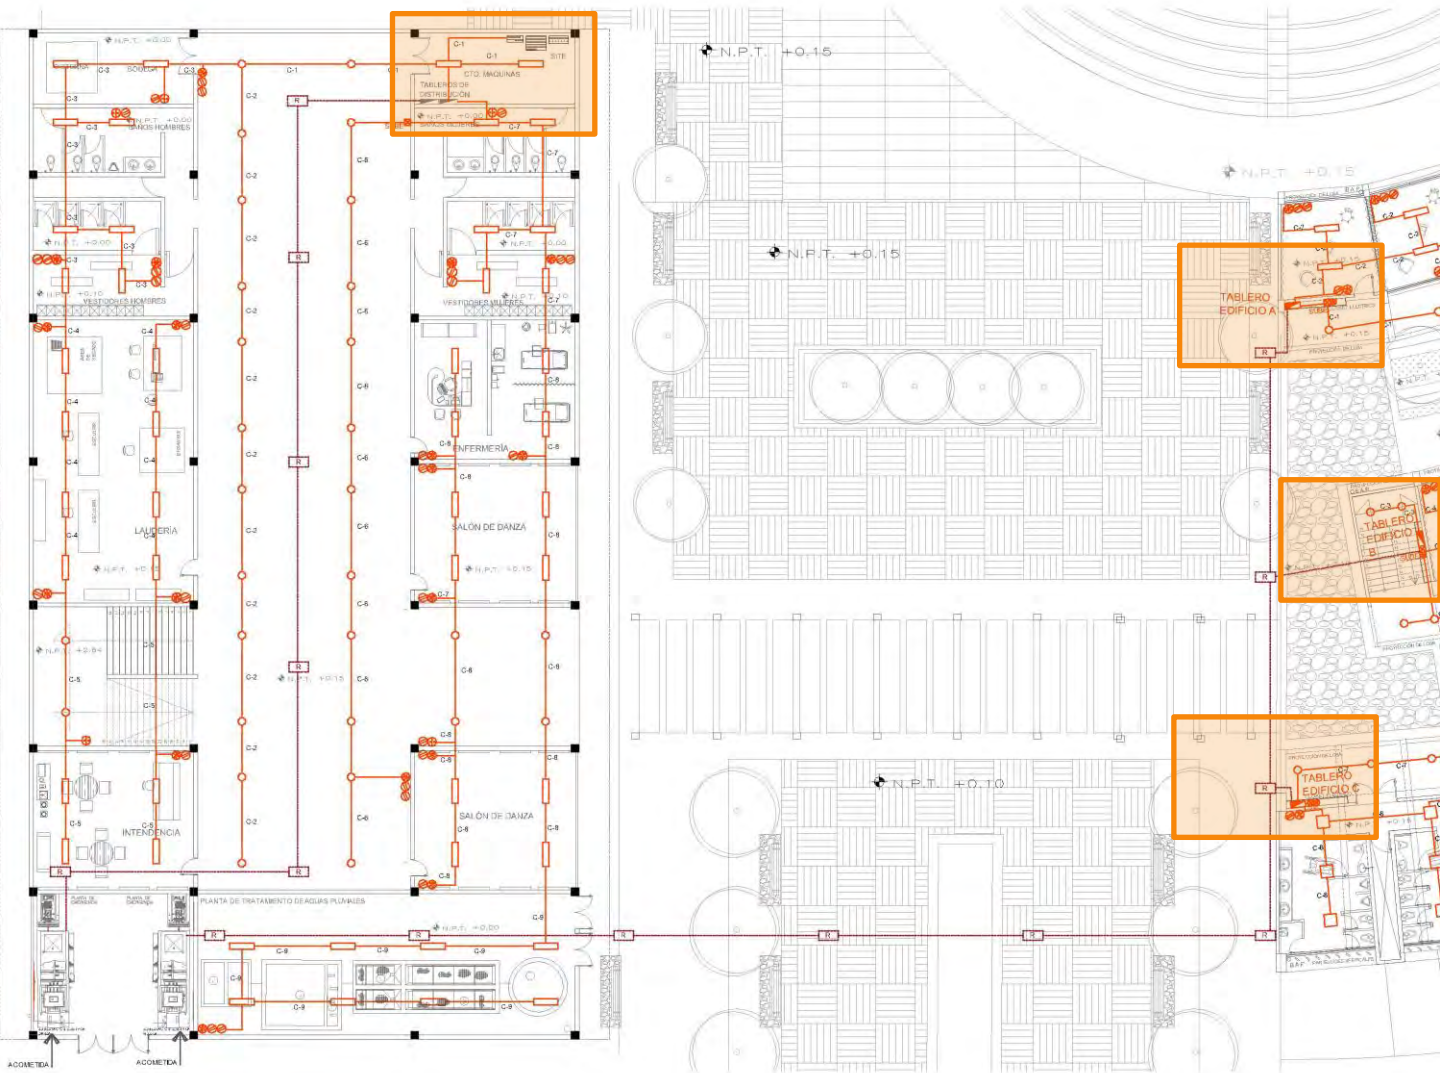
Planta de edificio de danza en donde se aprecian las ubicaciones de los tableros de distribución.
